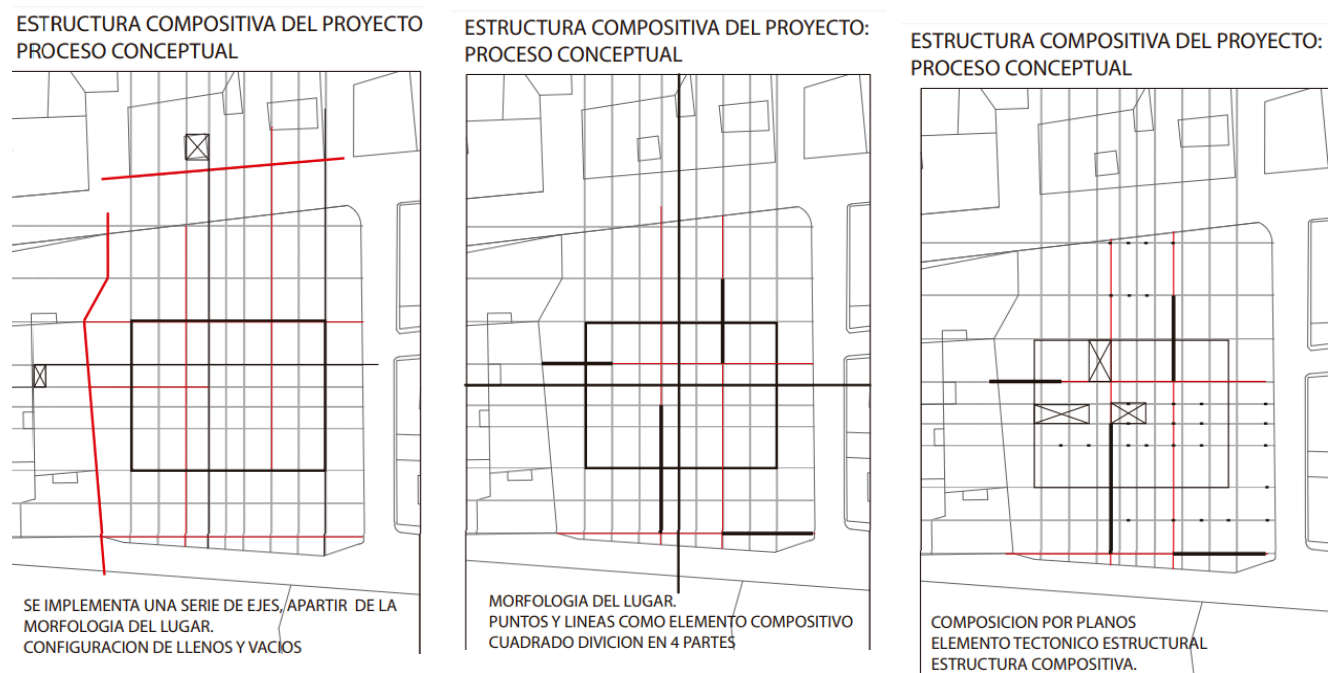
Fase propositiva de la propuesta arquitectónica (Sanchez J. D., 2018)
